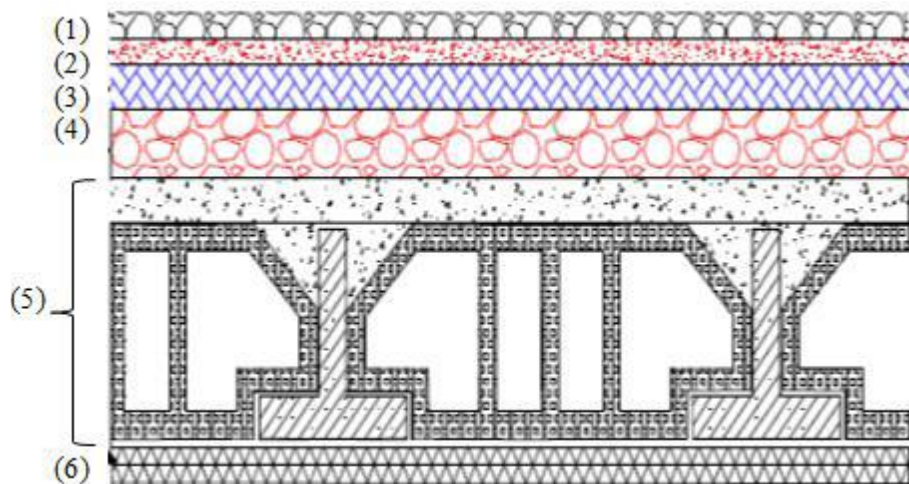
Coupe verticale du plancher terrasse à corps creux.
